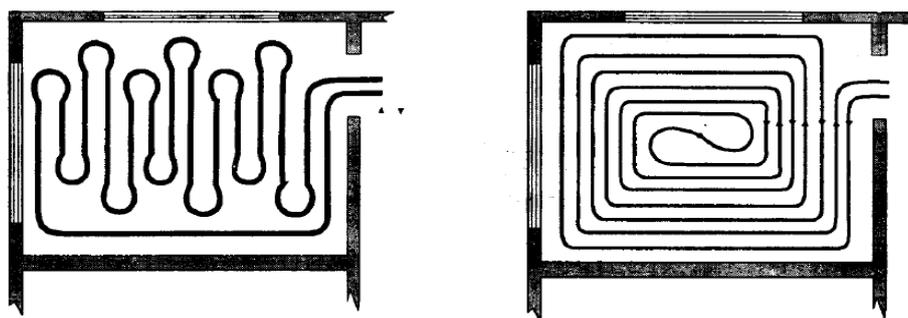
Способы прокладки трубопроводов системы напольного отопления
